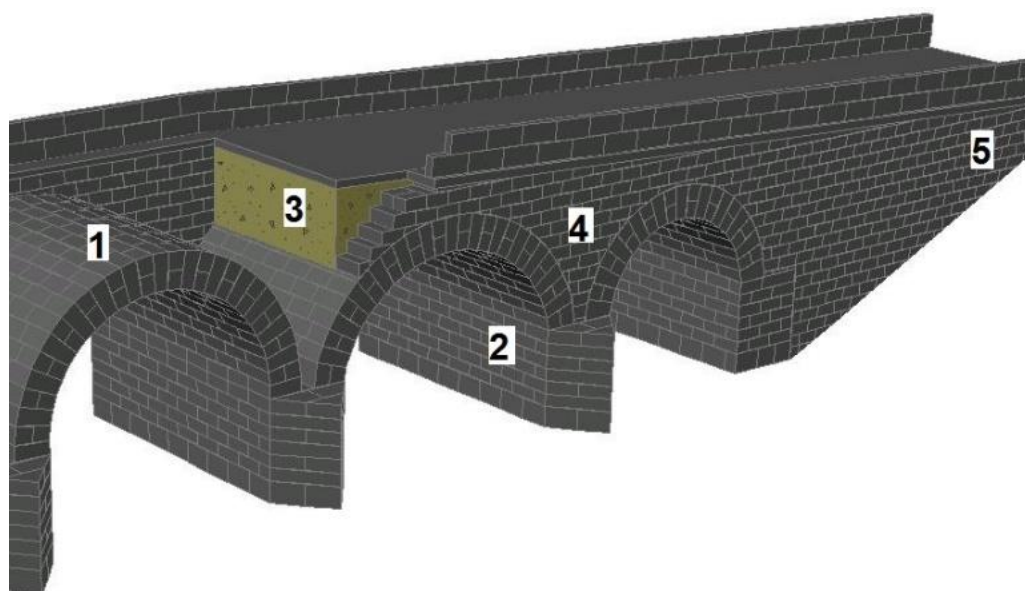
Principais elementos constituintes de uma ponte em arco de alvenaria. (1) – Arco; (2) – Pilar; (3) – Enchimento; (4) – Muro de tímpano; (5) – Encontro. Adaptado de [11].
